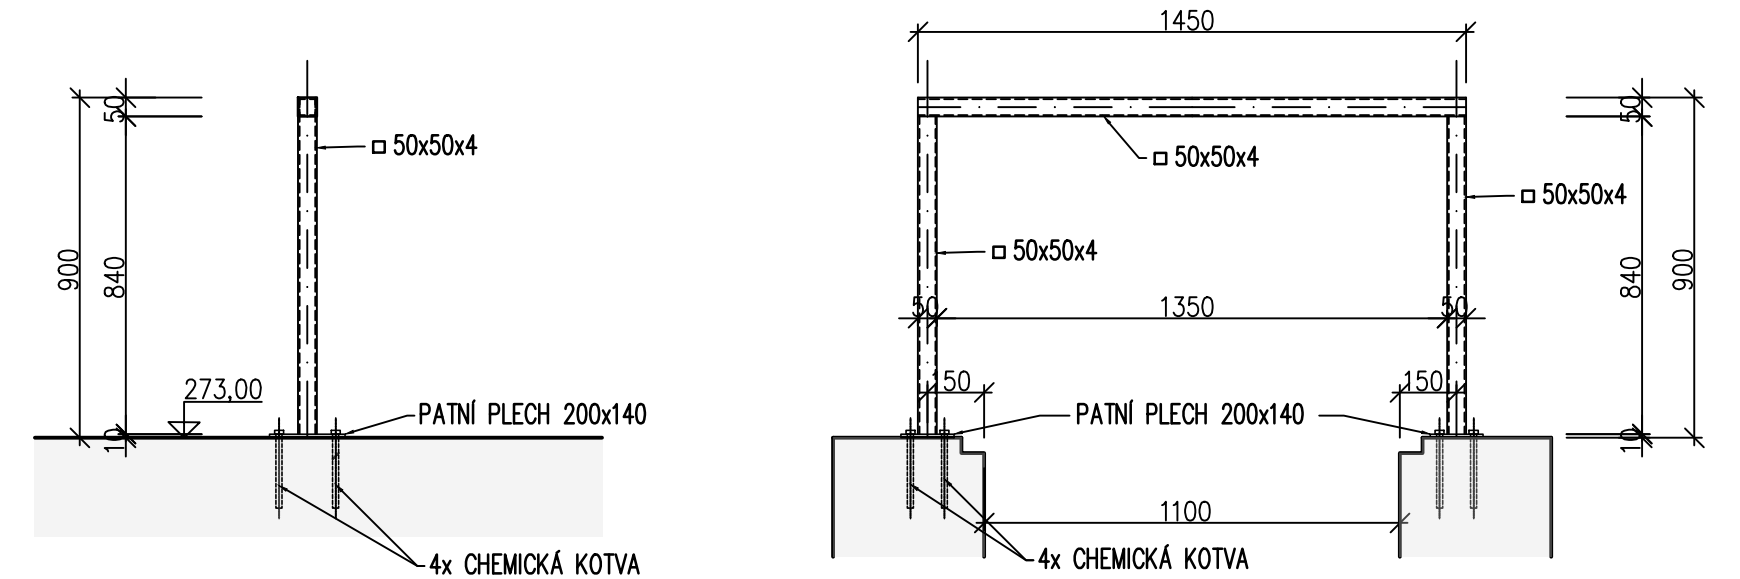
DETAIL VTOKOVÉ MŘÍŽE – Č. POL. 17
